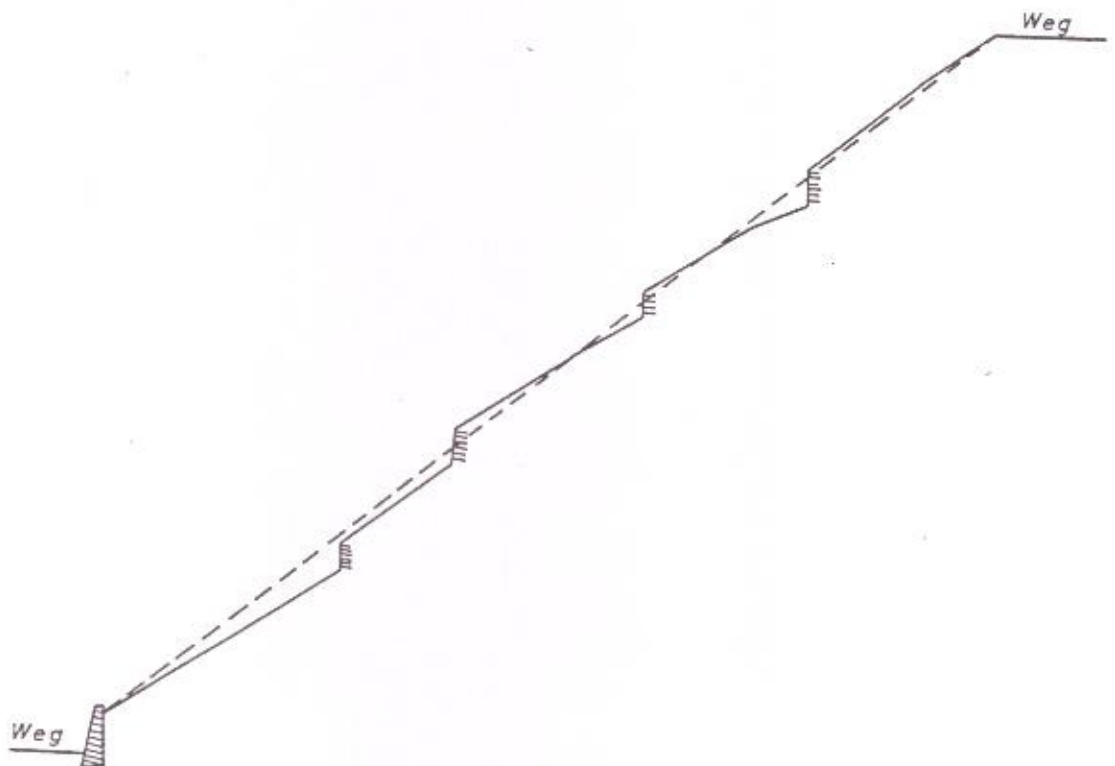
Modellhafte Darstellung des Geländes vor und nach der Planierung und dem Mauerbau am Steilhang
